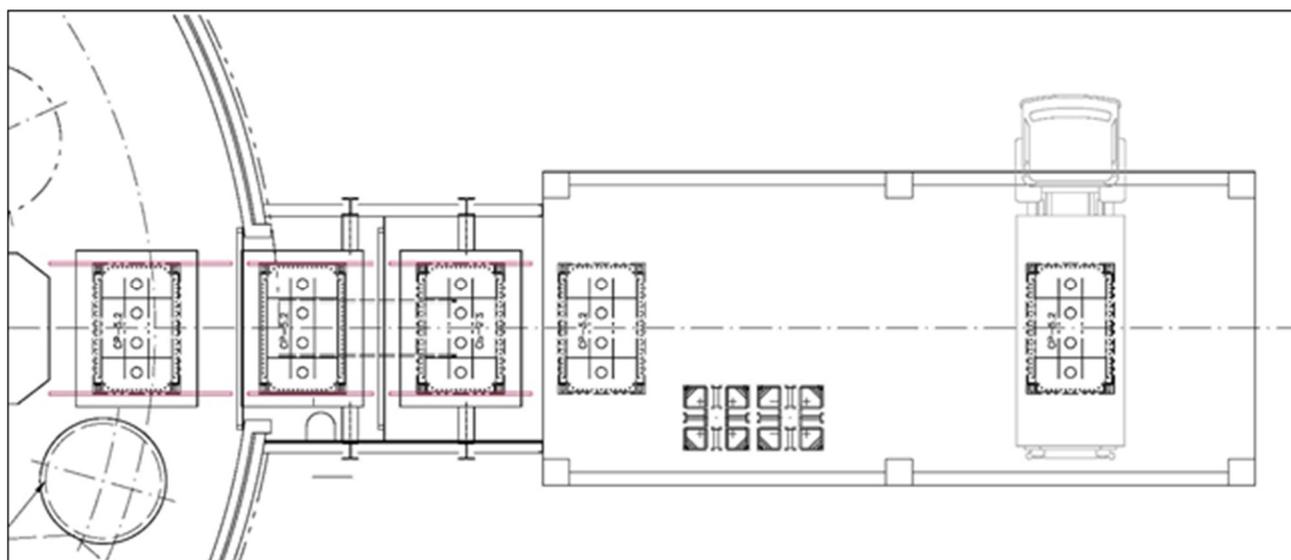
Layout sistemazione accesso lato Sud al Contenitore Stagno (pianta)
